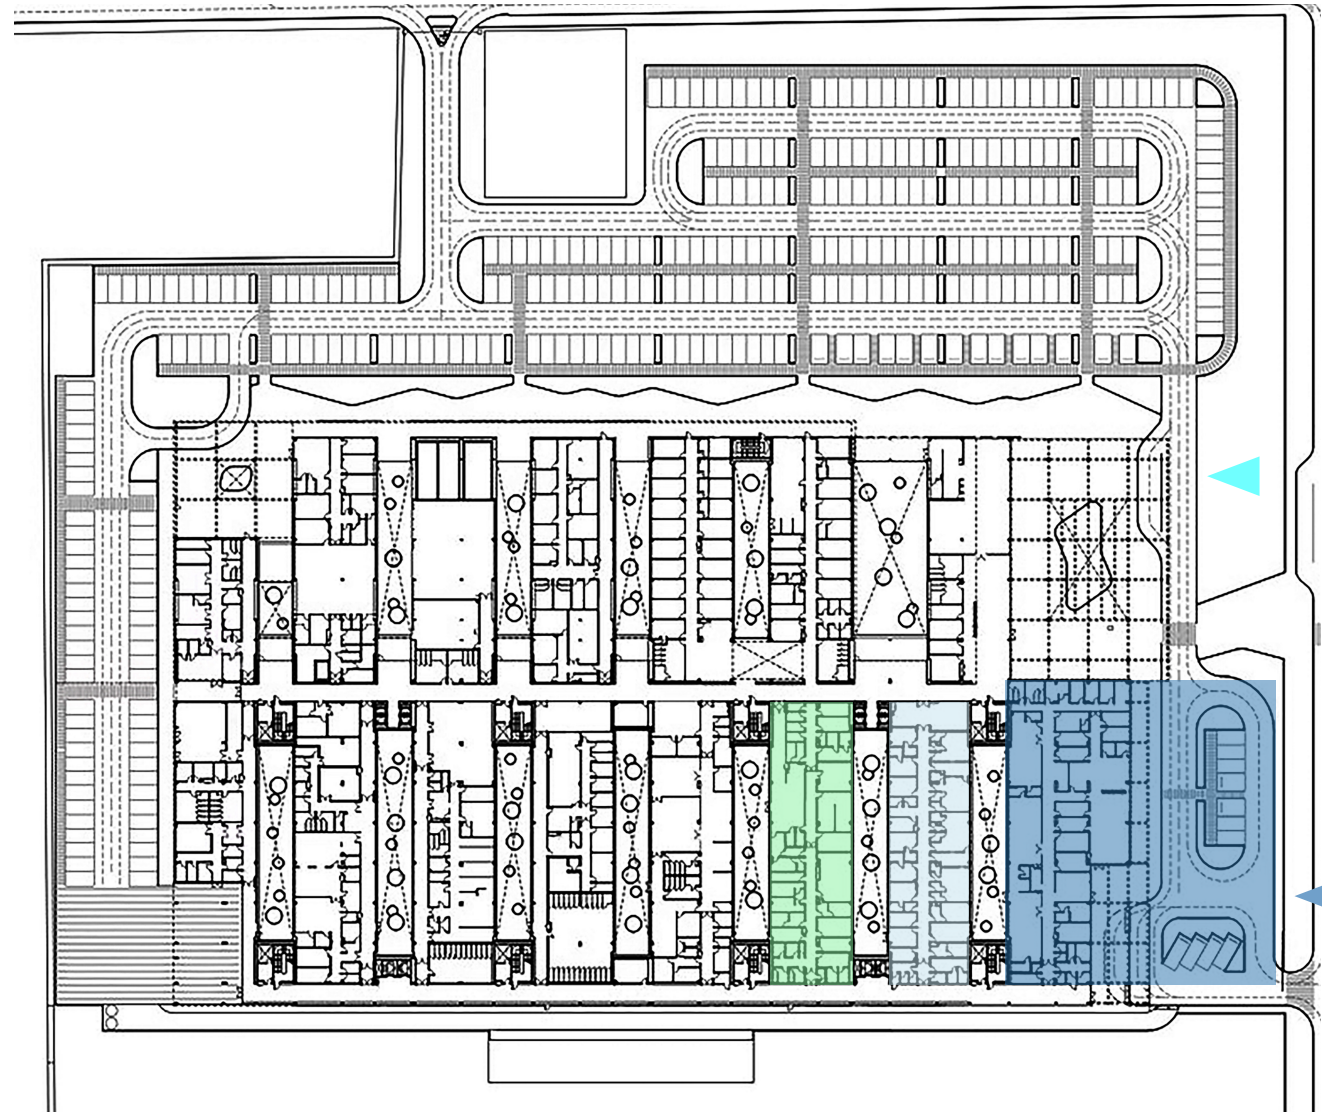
| Plano Arquitectónico (Autores,2020).
